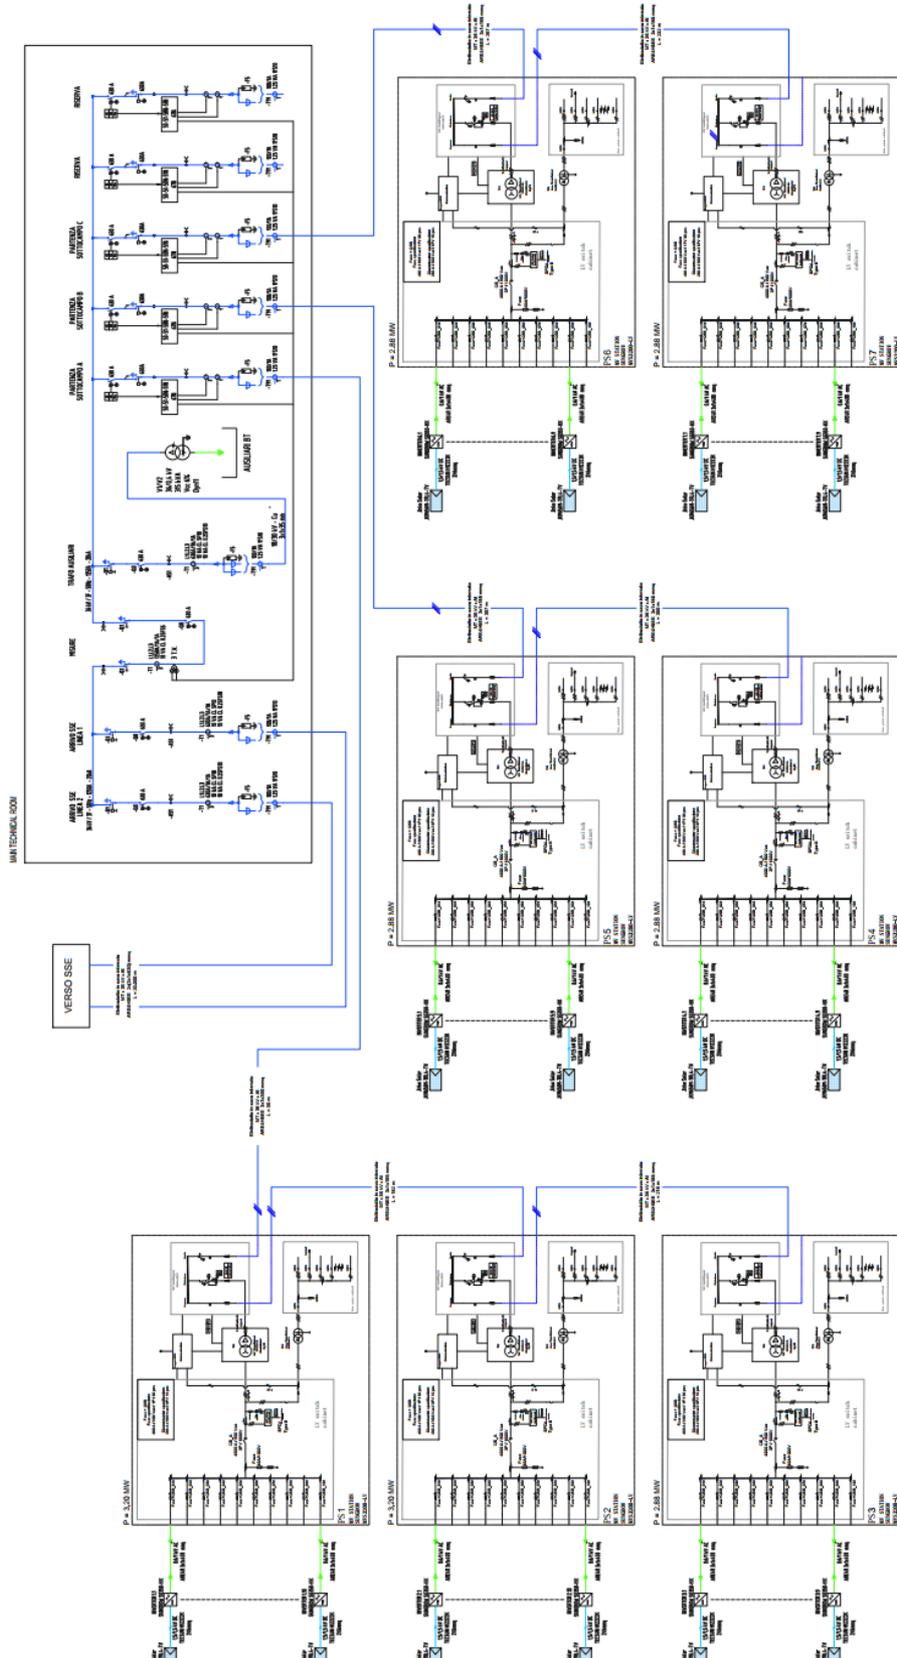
Schema unifilare 36/BT di collegamento impianto – MTR
